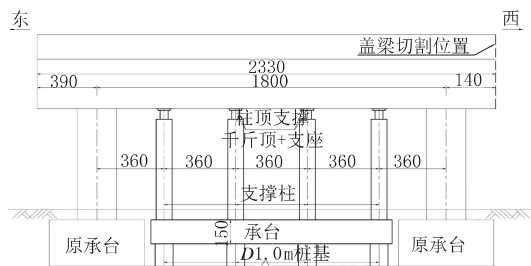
支撑柱接承台桩基础立面布置图(单位:cm)
